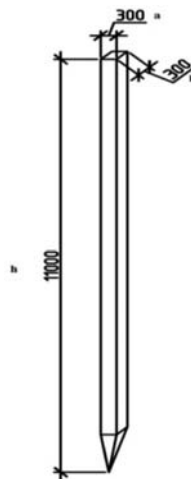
Вид призматической сваи с типоразмера (типовое конструктивное решение).
